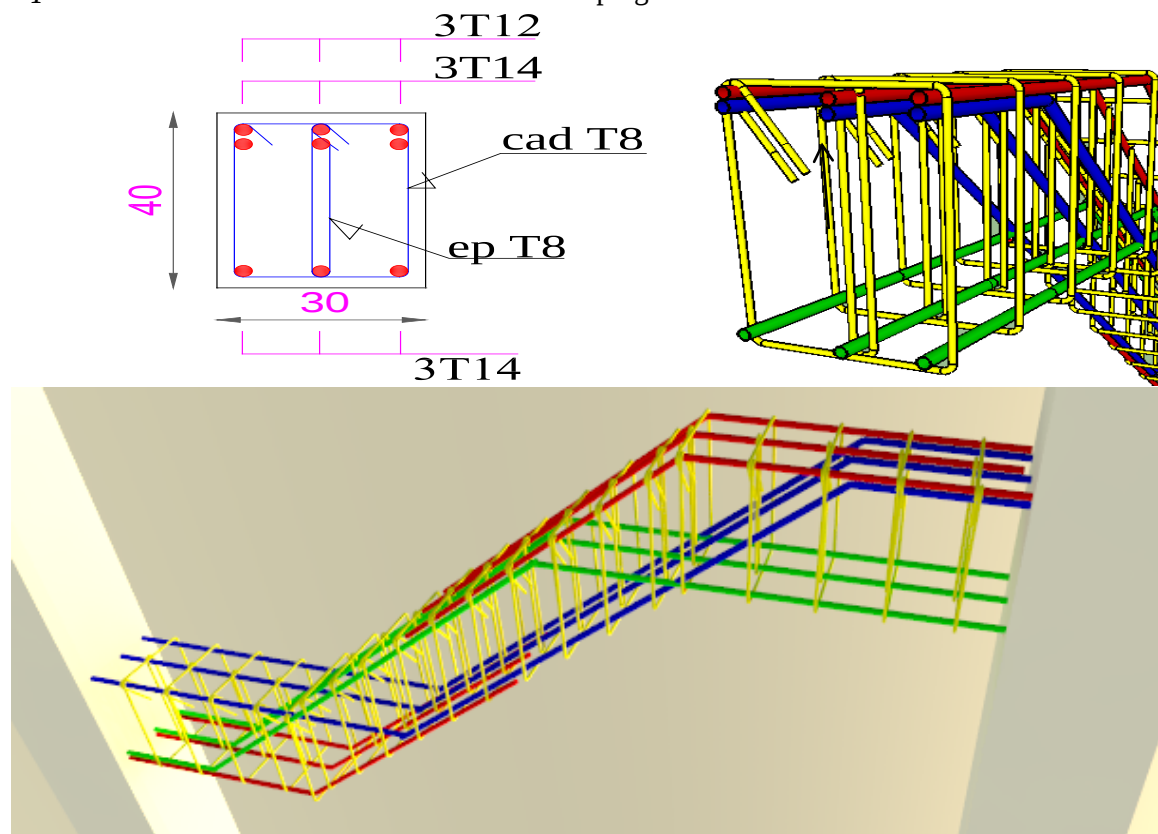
Schéma de ferrailage de la poutre brisée de l'escalier.
